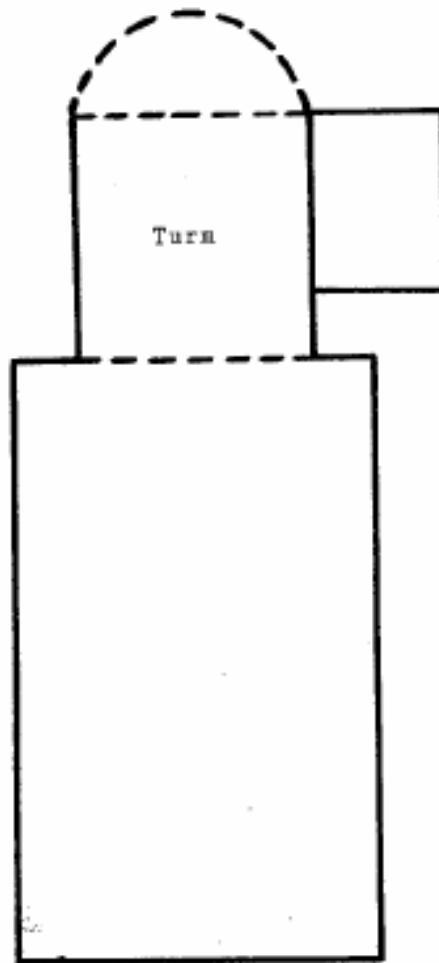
Abb. I: Grundriss der Kirche vor 1745 mit der an den Turm angebauten sog. „Alten Sakristei“
